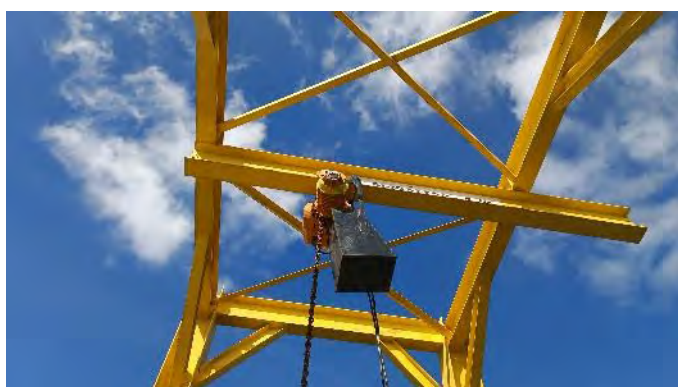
Barragem Boa Vista –Torre da TUD
